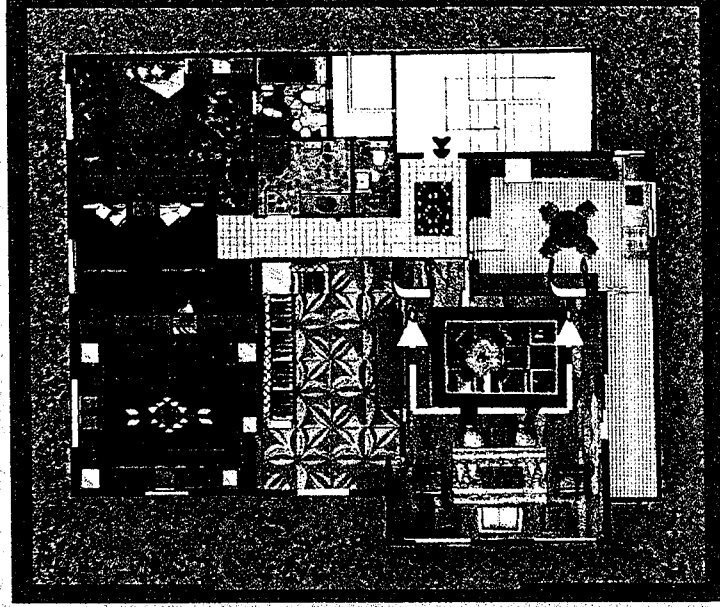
/١٢٧) مسقط أفقي يوضح قطاعاً بغرفة المعيشة
